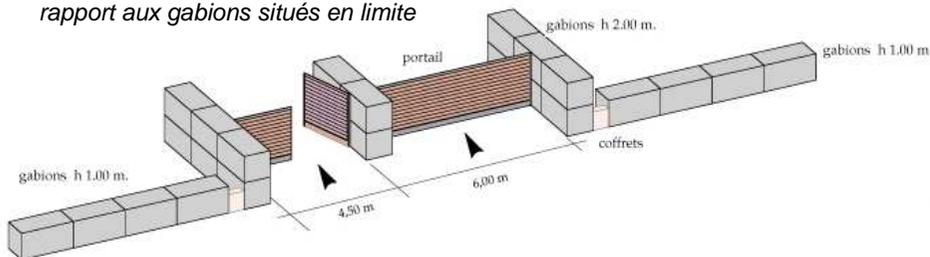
Cas d'un portail simple en retrait par situés en limite
